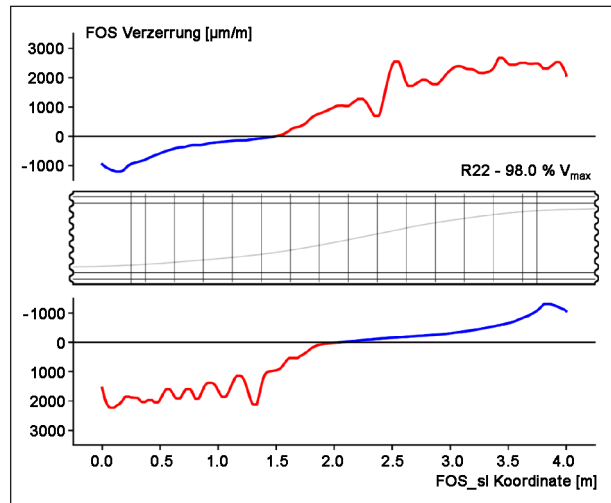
R22 – Verzerrung entlang der Längsbewehrung auf Bruchlastniveau
